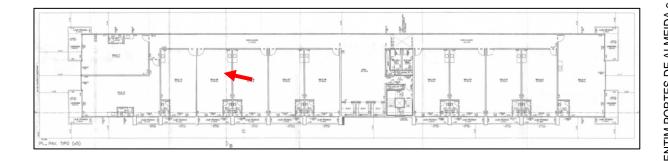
Segundo pavimento. Destaque para trecho da estrutura degradada pela exposição às intempéries.
